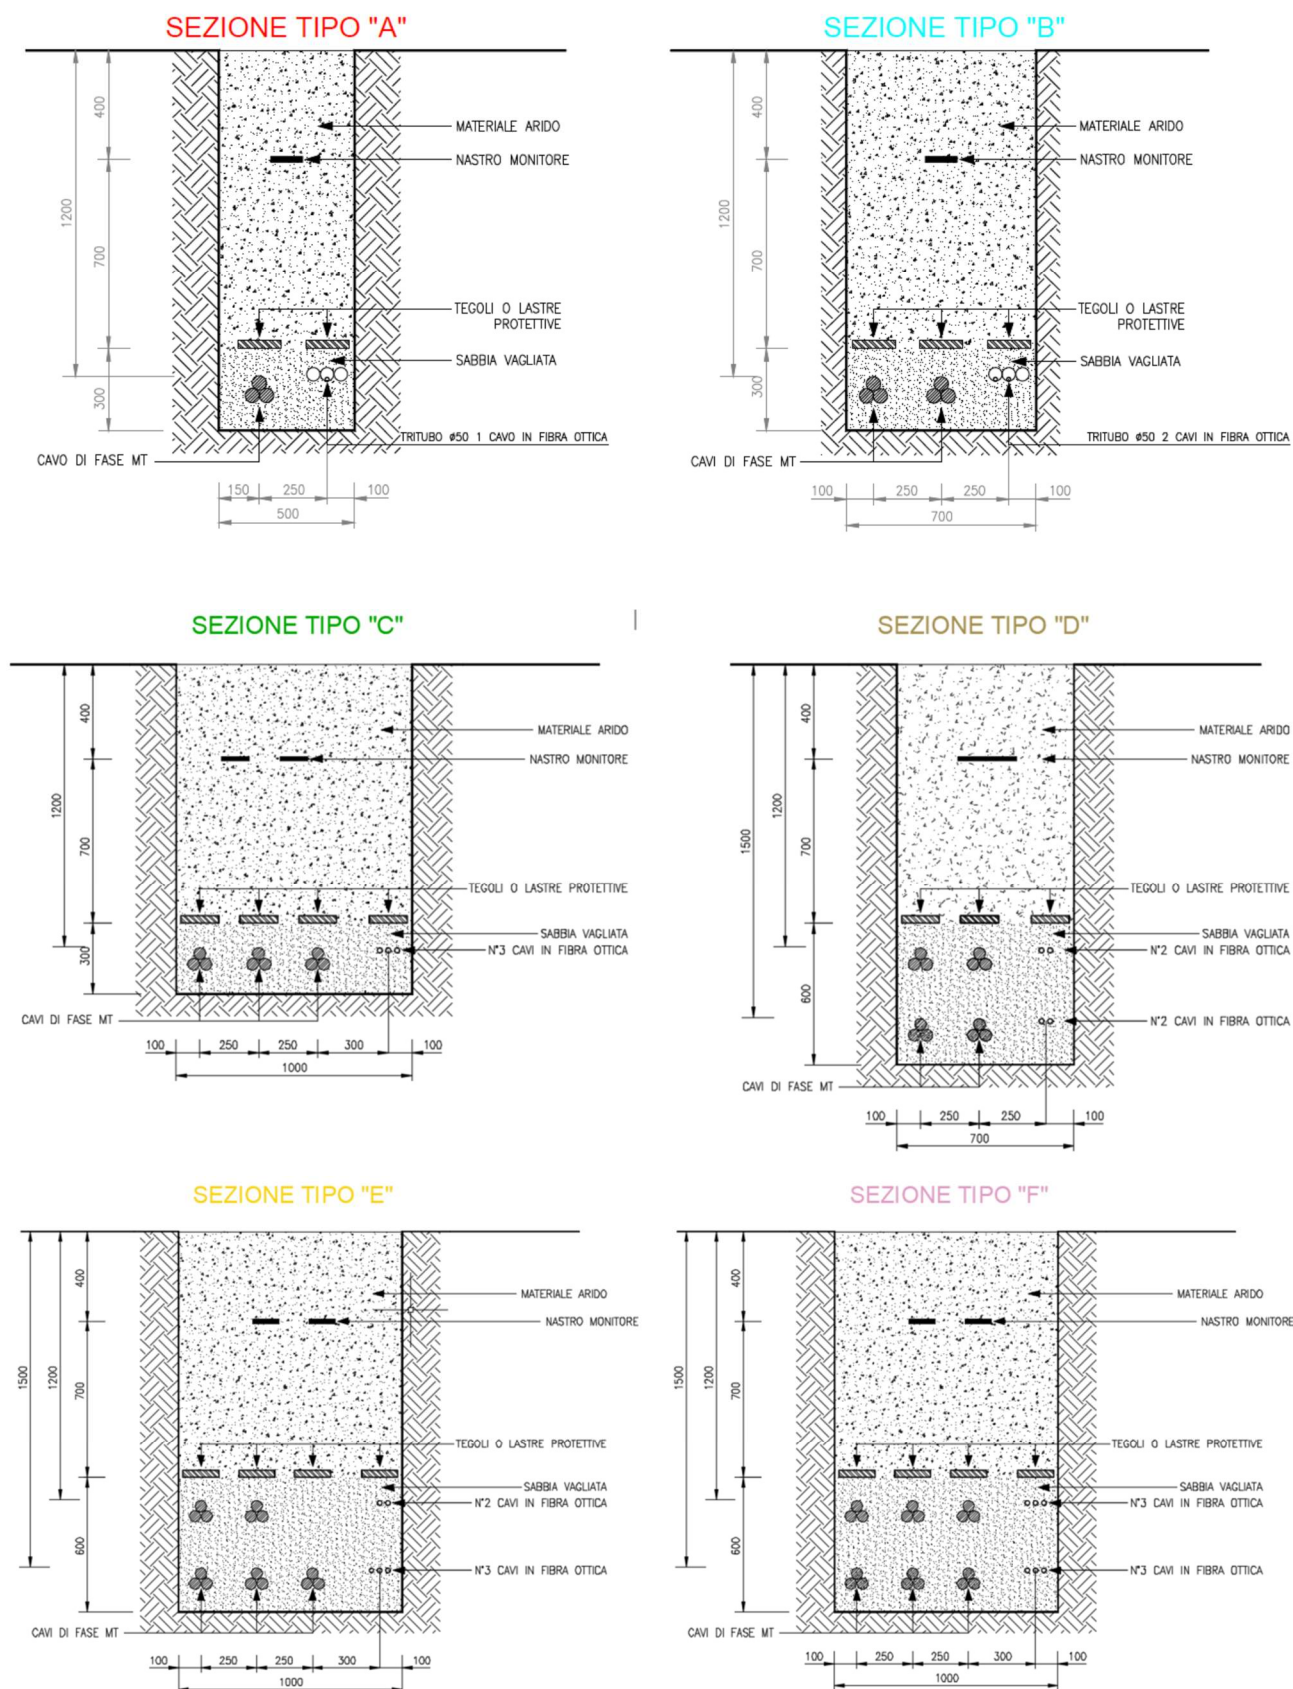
Sezione tipica di posa della linea in cavo su strade sterrate
